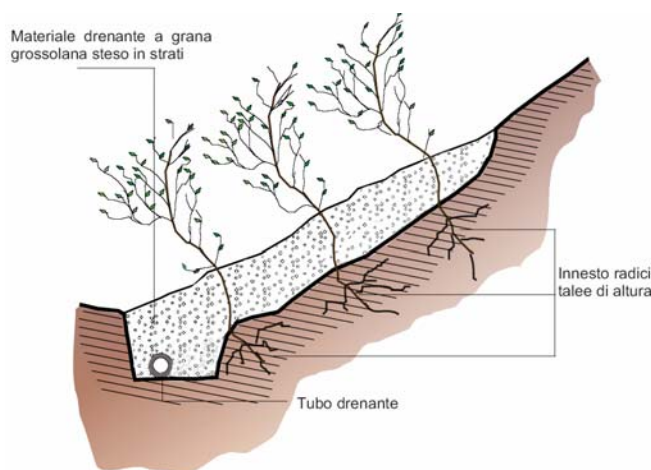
Schema di un cuneo drenante. Il materiale drenante è posizionato sulla base del versante dopo averne effettuato una riprofilatura (da ANPA, 2002) -
